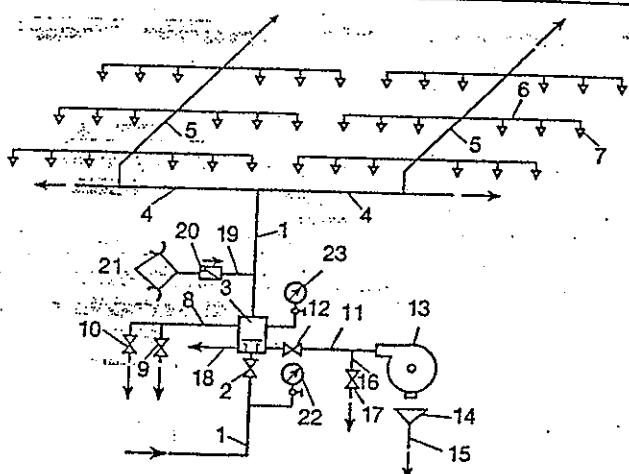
Schema de funcționare automată a instalației cu sprinklere în sistem apă - apă:
